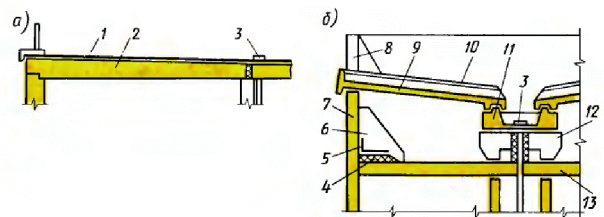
Сборные железобетонные бесчердачная (а) и чердачная (б) крыши: 1 — кровельный ковер, 2 — легкбетонная панель, 3 — водоприемная воронка, 4 — минераловатный вкладыш, 5 — полоса рубероида, 6 — треугольный опорный элемент, 7 — опорная фризровая панель, 8 — ограждение, 9 — железобетонная кровельная панель, 10 — плита-нащельник, 11 — железобетонный водосборный лоток, 12 — несущая балка под лоток, 13 — утепленная панель перекрытия верхнего этажа
